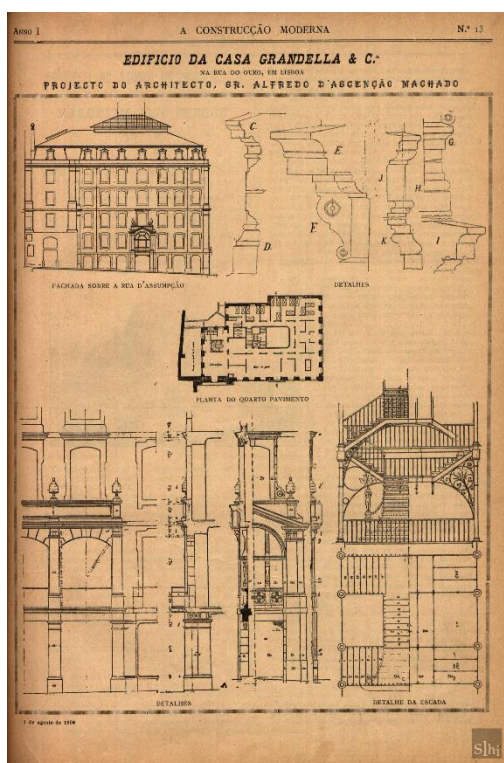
Capa da revista *A Construção Moderna*, N.º13, agosto de 1900. Disponível em: http://ric.slhi.pt/A_Construcao_Moderna/revista
